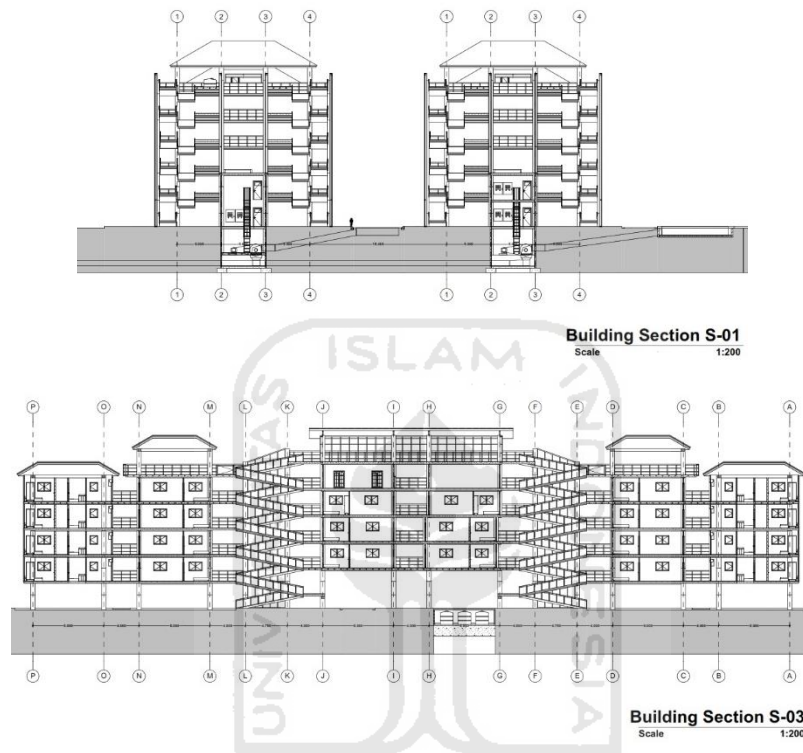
Tampak Bangunan Hasil Desain
